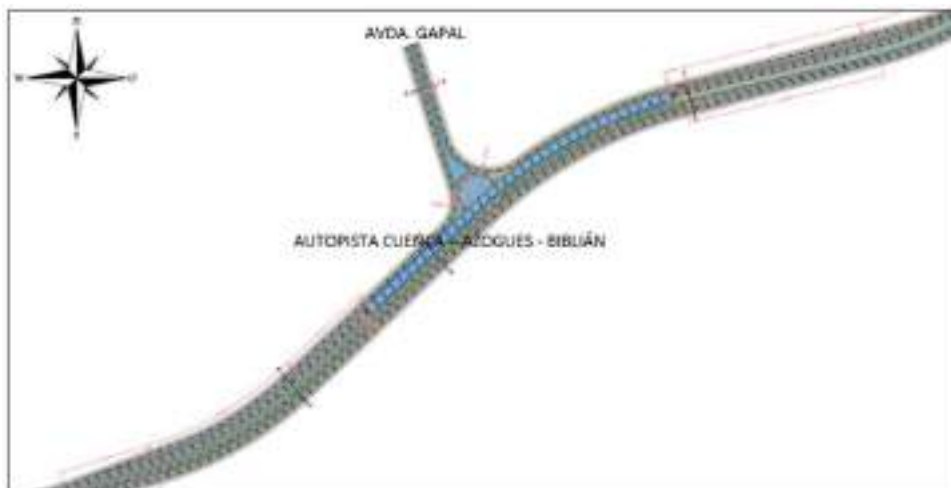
Diseño en planta del distribuidor Gapal, vista de vías elevadas.
